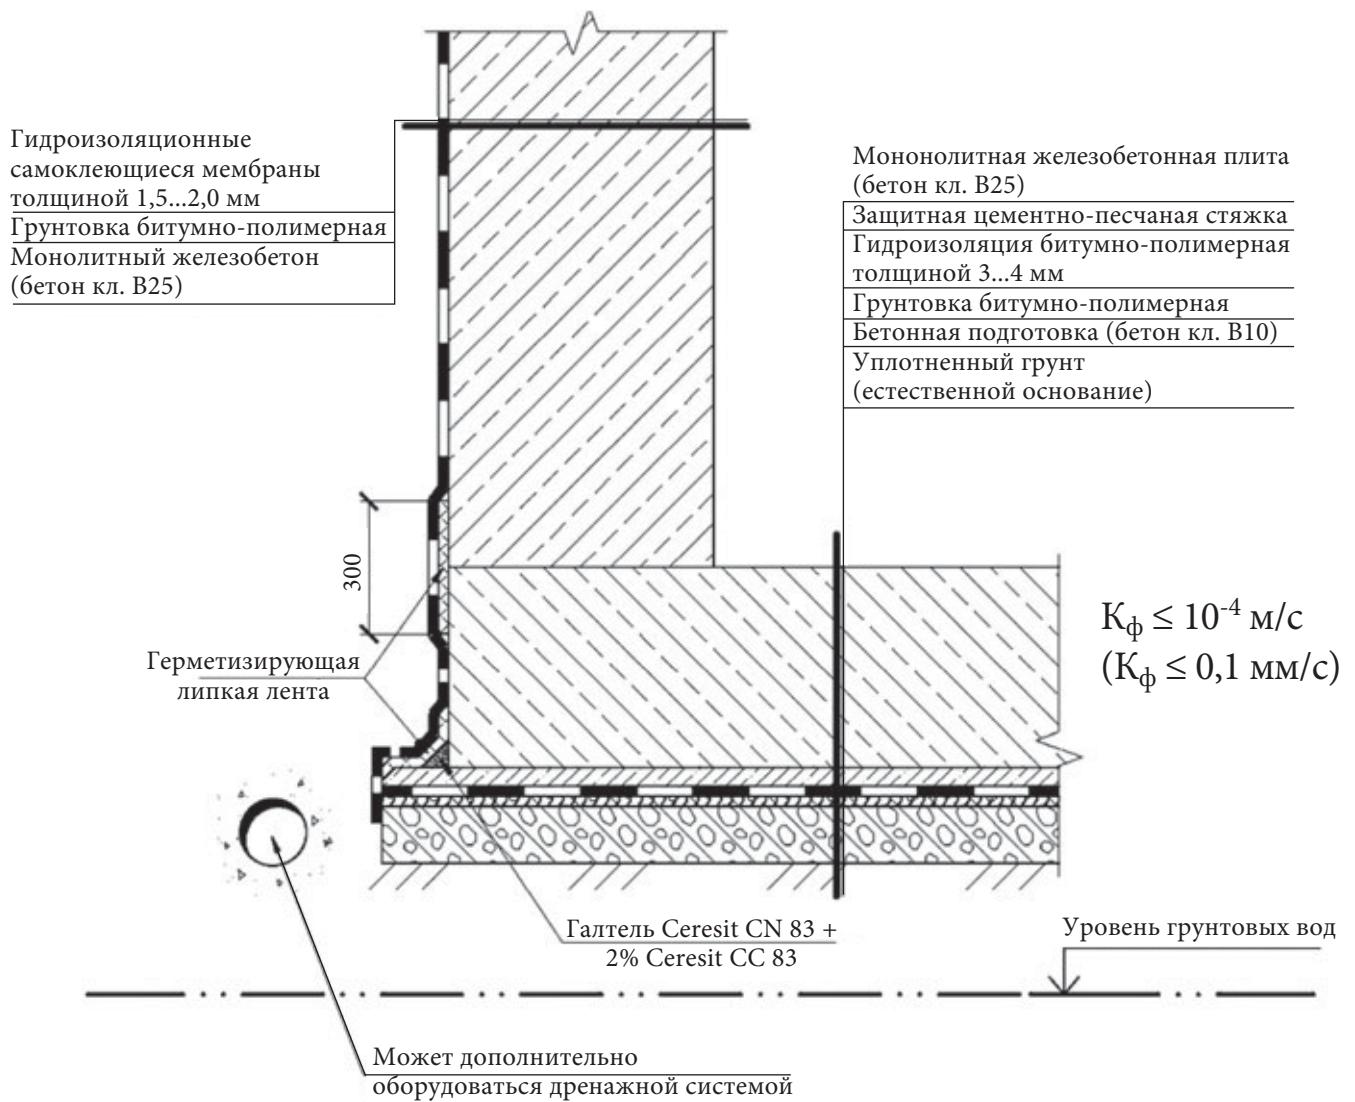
Гидроизоляция бетонных плит оснований и стен подземных сооружений в условиях воздействия не скапливающейся фильтрационной воды
